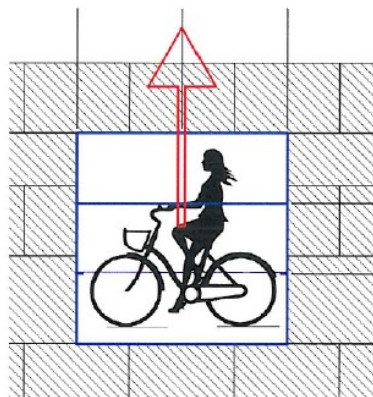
Przykładowy sposób układania betonowych płyt chodnikowych.
